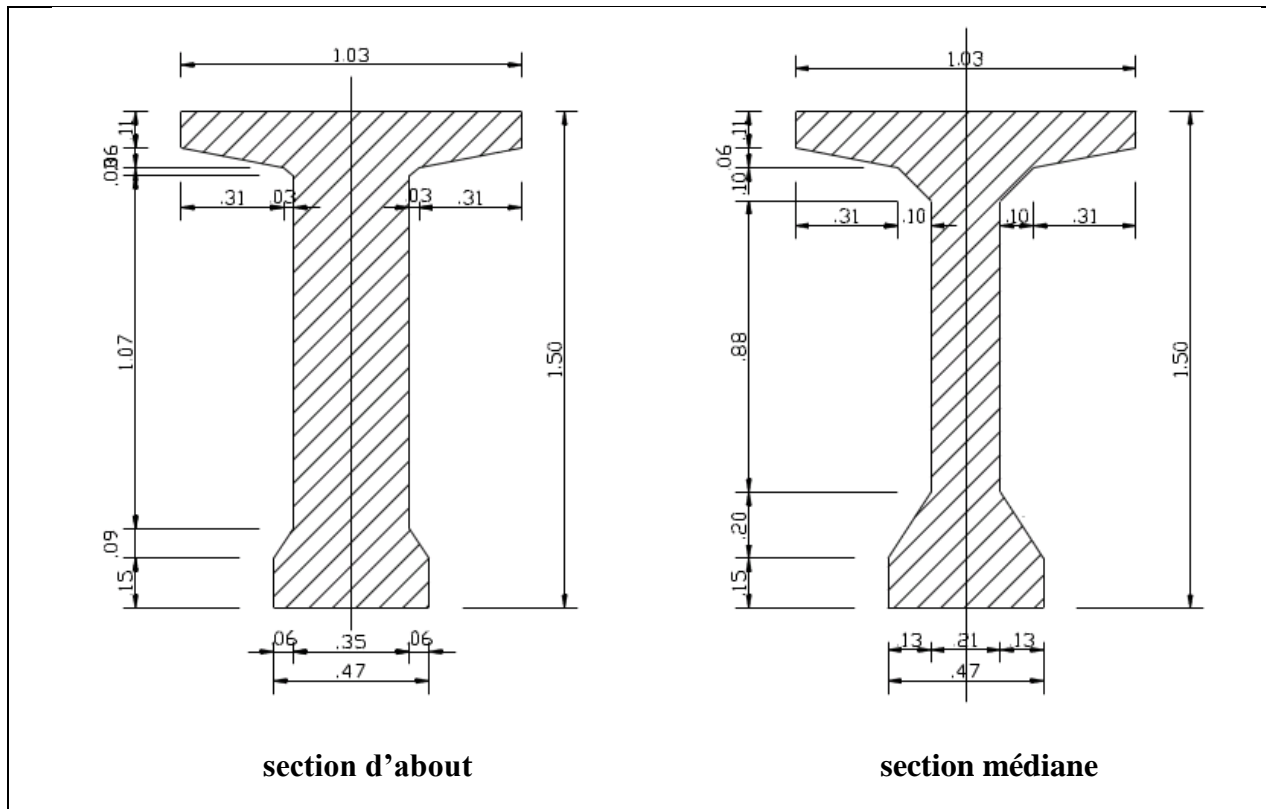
Détails des sections des poutres de longueur 33.40m.
